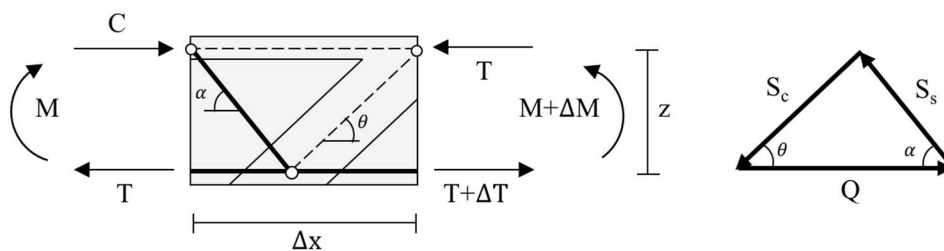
Particolare di un elemento di trave di lunghezza Δx
